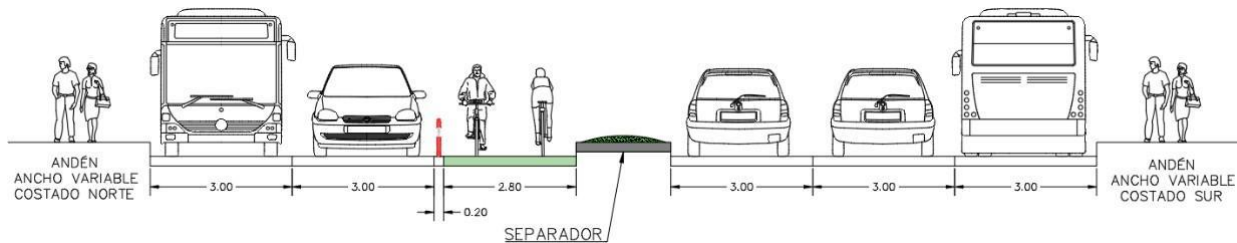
Perfil vial crítico ciclorruta Av. Calle 63 entre Carrera 16 y Av. Carrera 50 (perfil vial crítico
